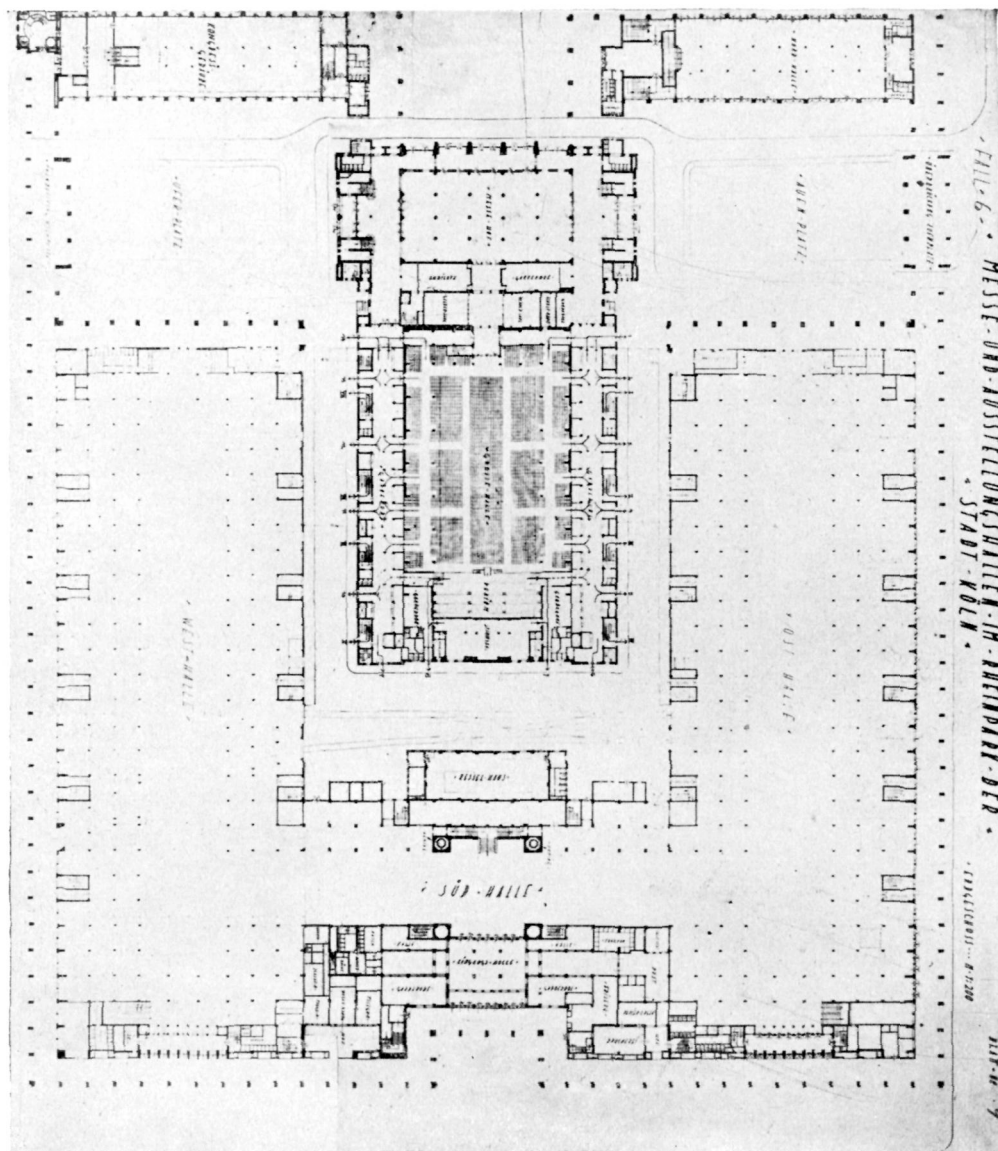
Messe- und Ausstellungshallen Köln. Erdgeschoß-Grundriß
